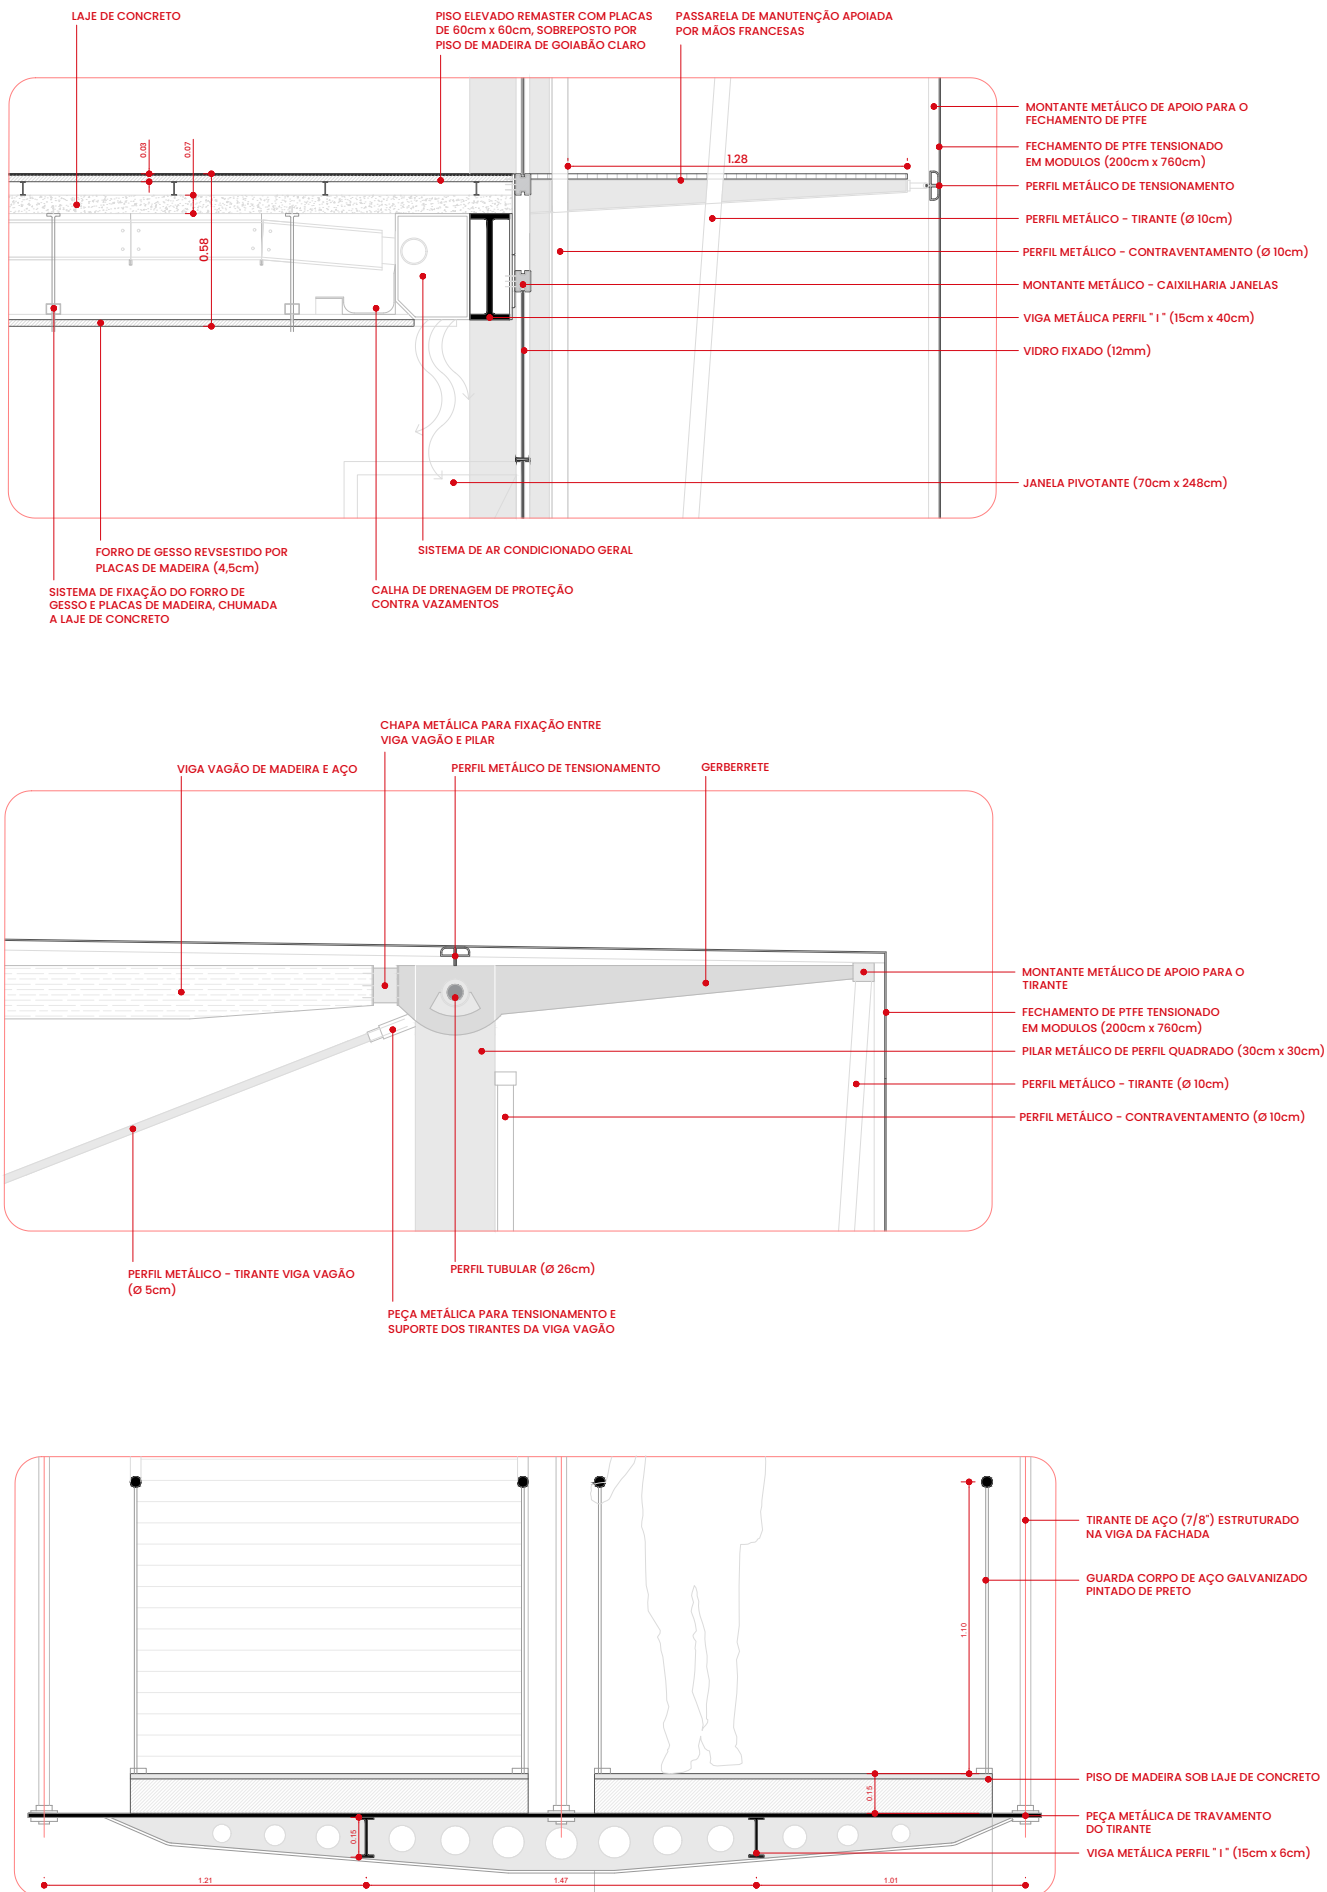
Detalhamento de elementos construtivos e estruturais
